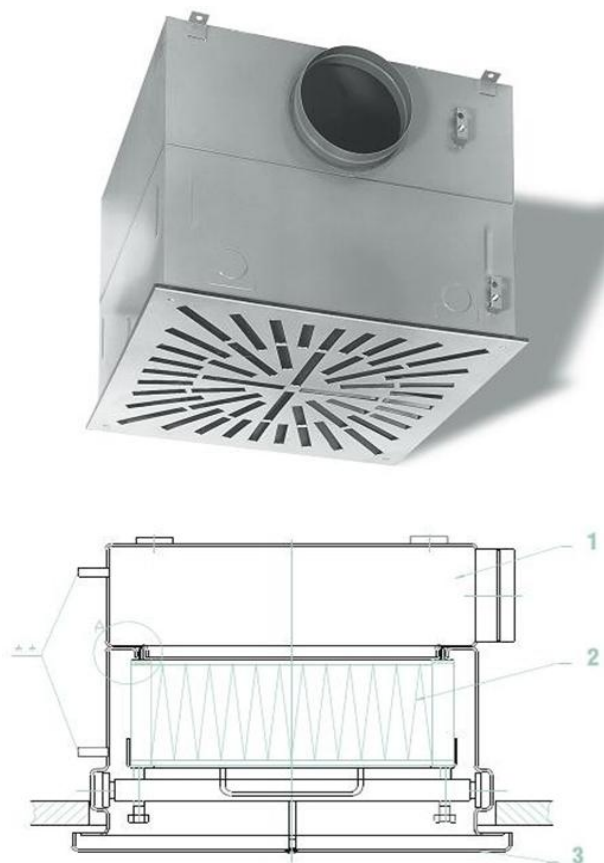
Загальний вид і схема повітророзподільника типу AFV
